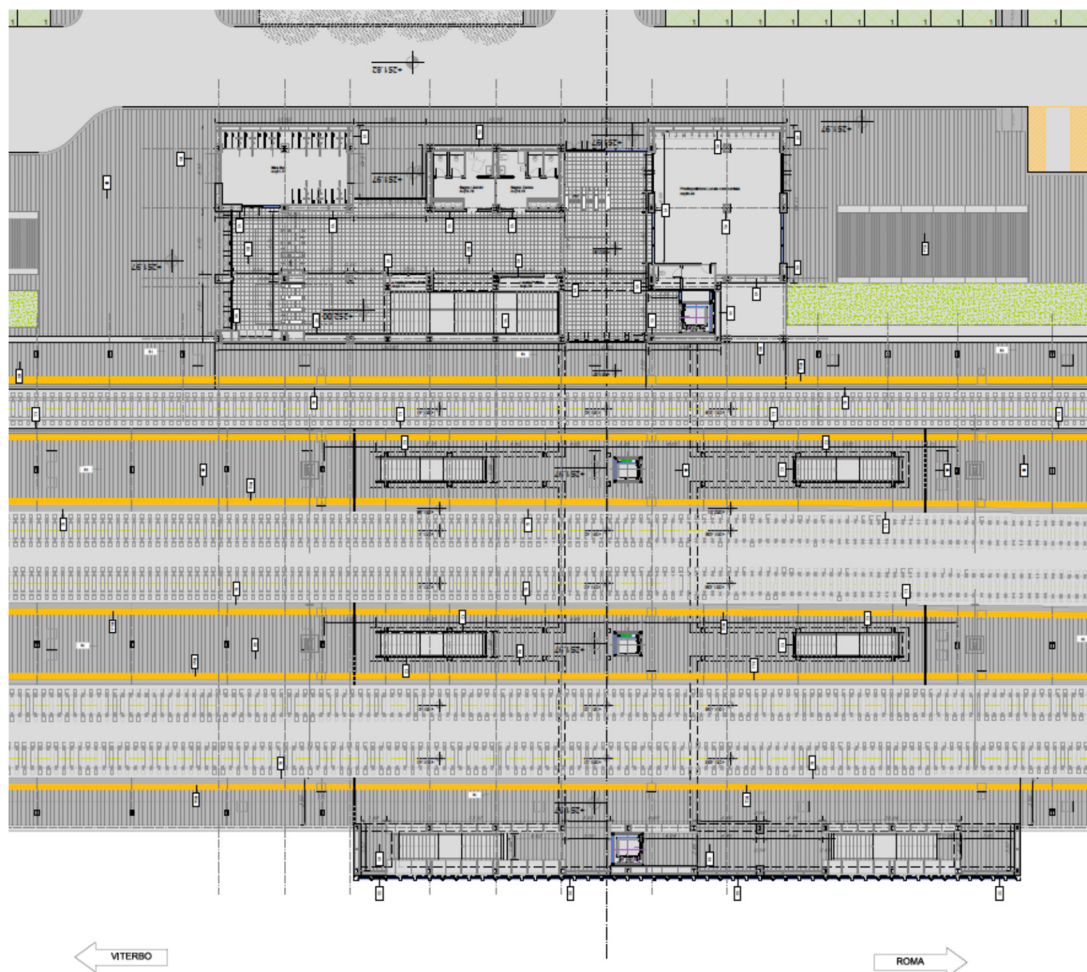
Planimetria quota banchine della stazione di Vigna di Valle
